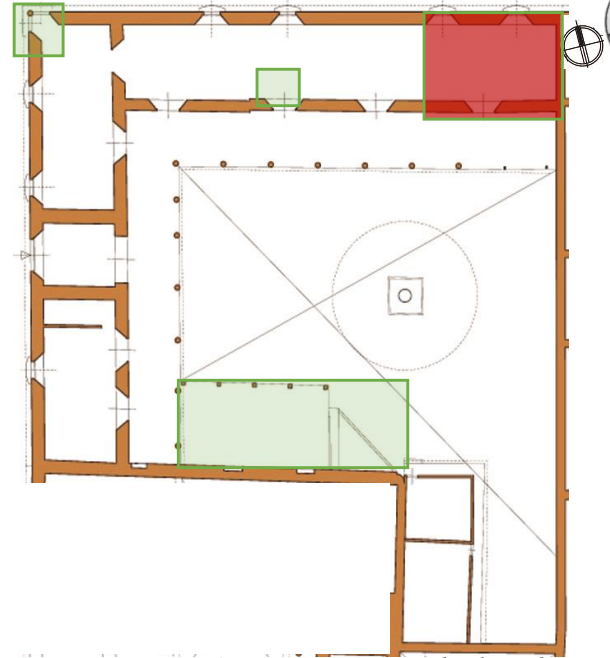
A consecuencia de los daños estructurales ocasionados por los terremotos de 2001, colapsa un tercio de la cubierta de la crujía norte, se apuntalan todas las columnas y el corredor Sur para evitar su colapso, también se refuerza rellenando vanos de una puerta y ventana esquinera para evitar el colapso de paredes. Fuente: Ídem.
